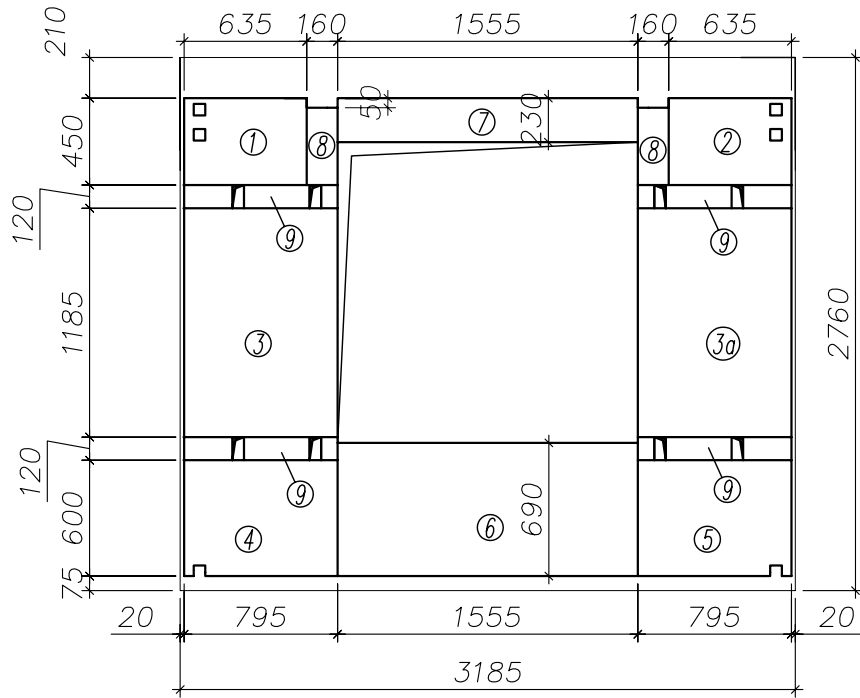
Наружная трехслойная стеновая панель с дискретными железобетонными связями и теплоизоляционным слоем из плит ПЕНОПЛЭКС® 35
